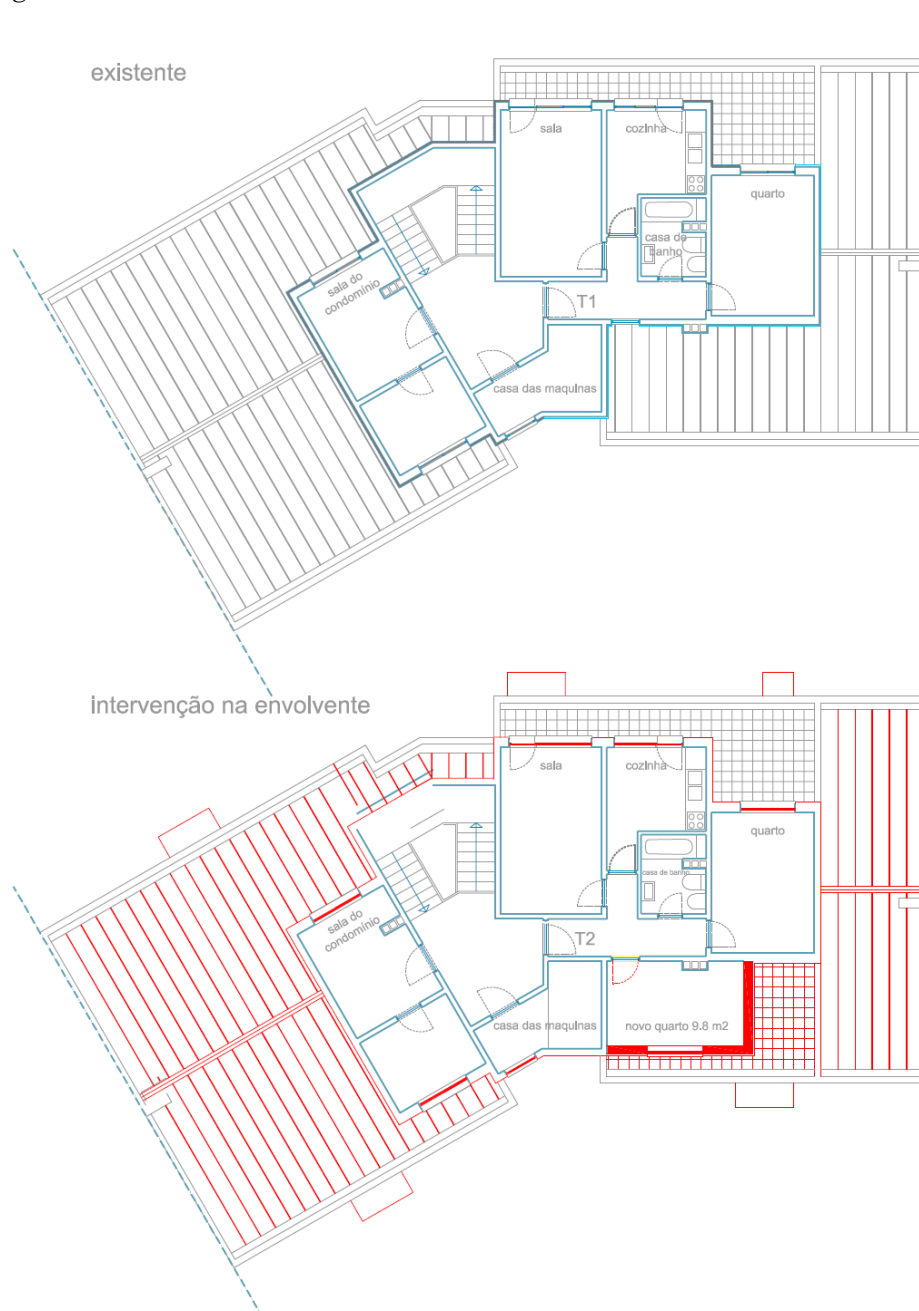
Tipologia “ângulo”. Planta do rés do chão (escala 1/200).
